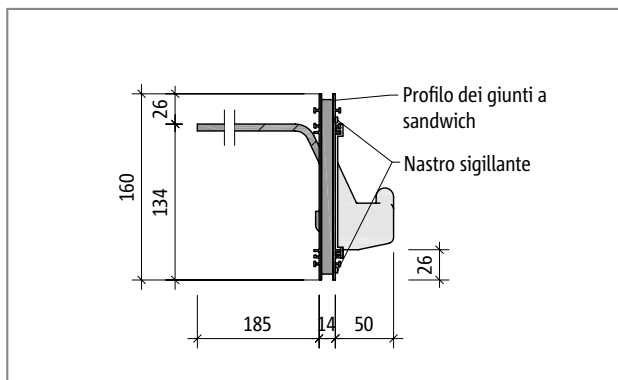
Schöck Tronsole® tipo T, sezione dell'elemento T...-H160
